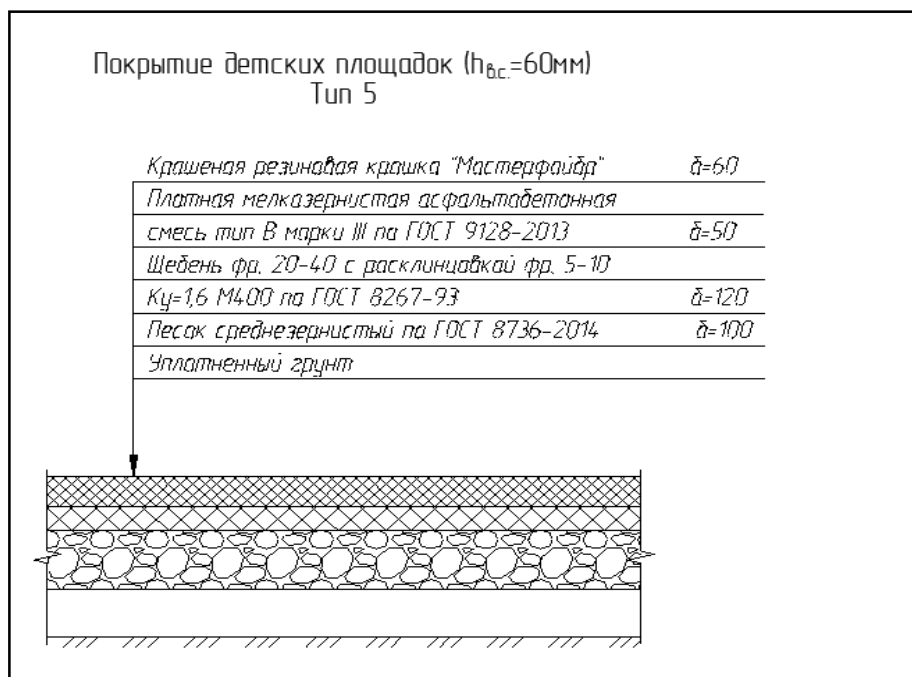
Устройство покрытия детских площадок. Тип 5
